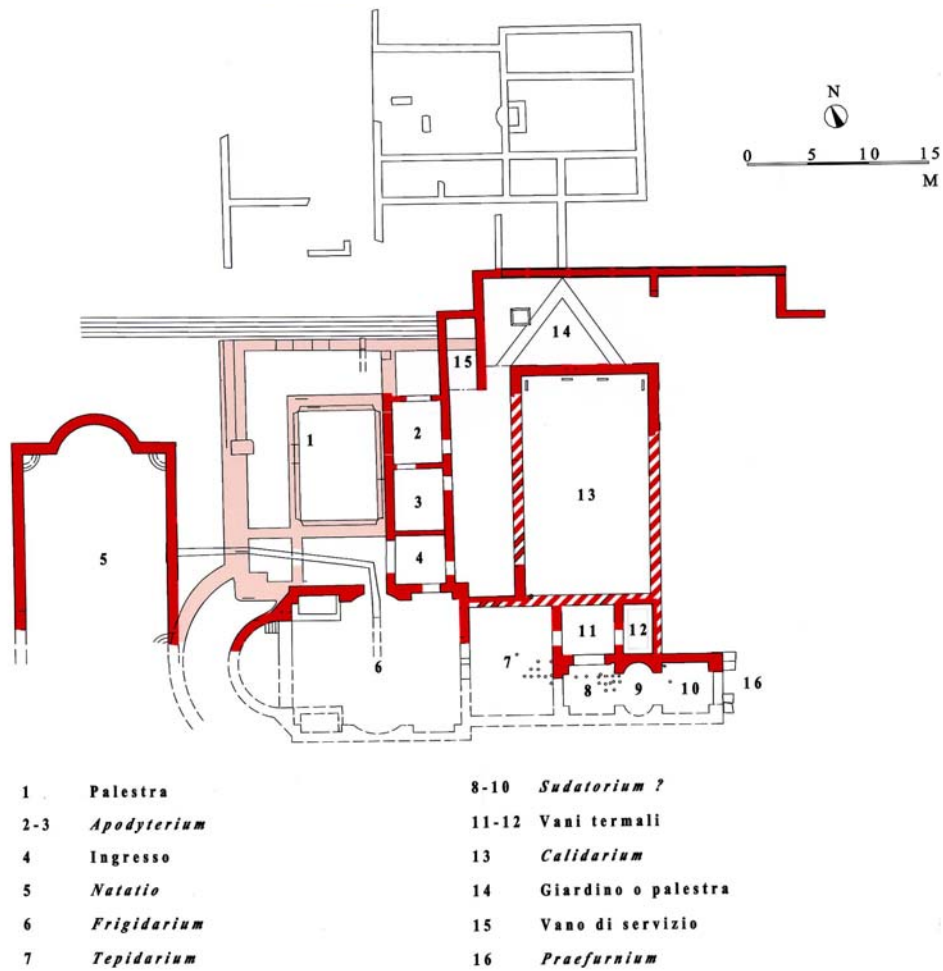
Albenga. Sponda destra del Centa. Edificio termale. In rosso le murature delle terme; in rosa le strutture di fondazione venute in luce sotto la pavimentazione della presunta palestra.
